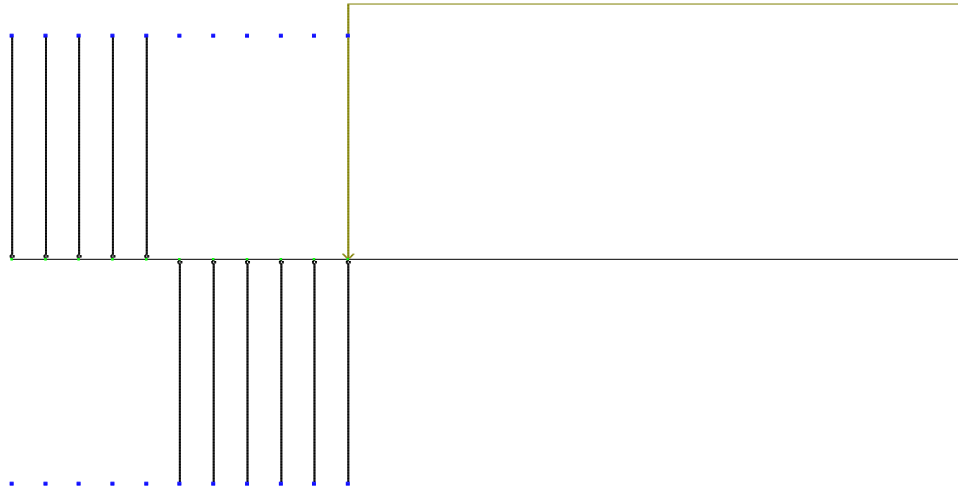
Опорний вузол розрахункової схеми після корегування.
